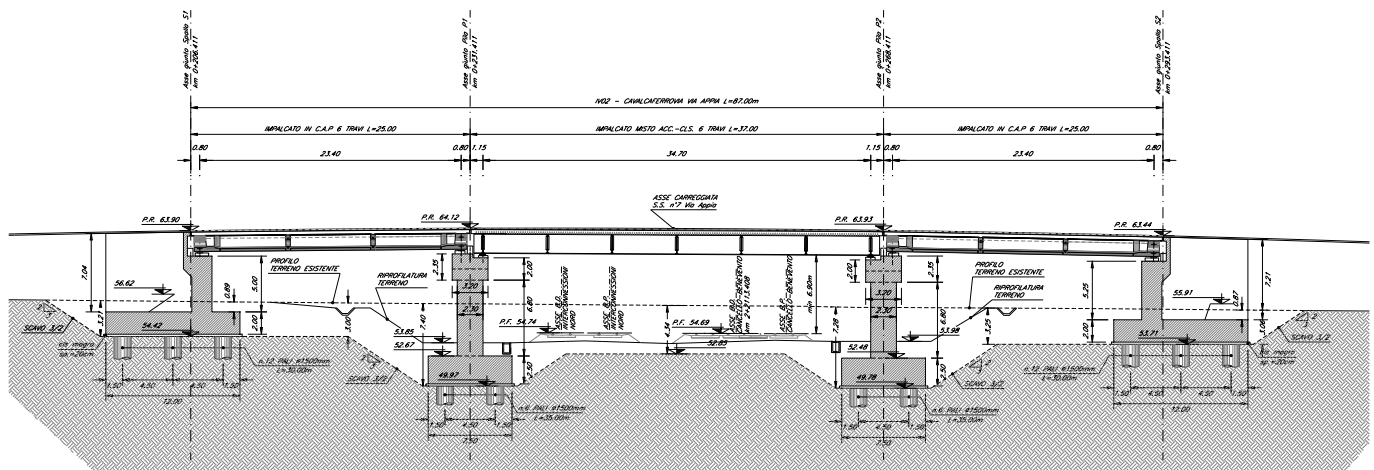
Sezione longitudinale del Cavalcaferrovia
